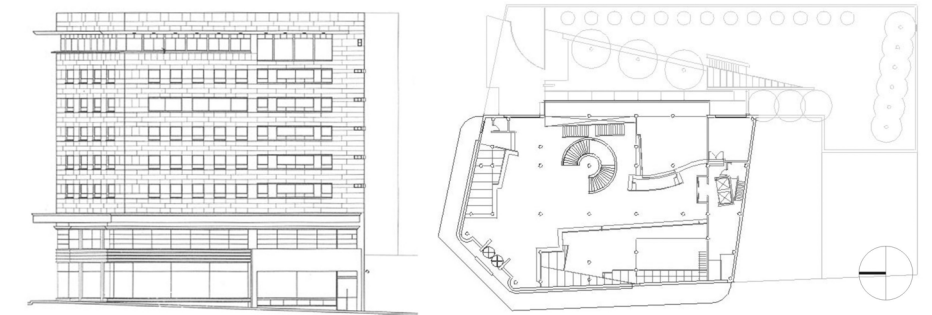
| Fachada oeste y planta baja de la intervención.
